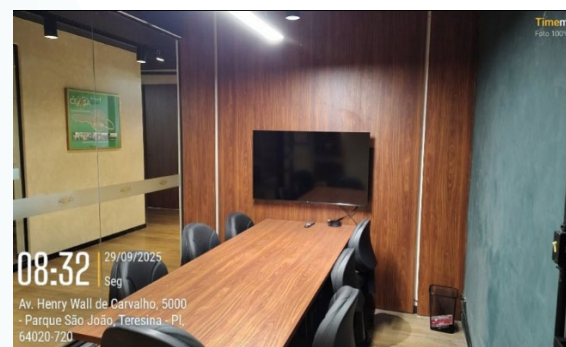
Execução de perfil amadeirado sobre tecto rebaixado
